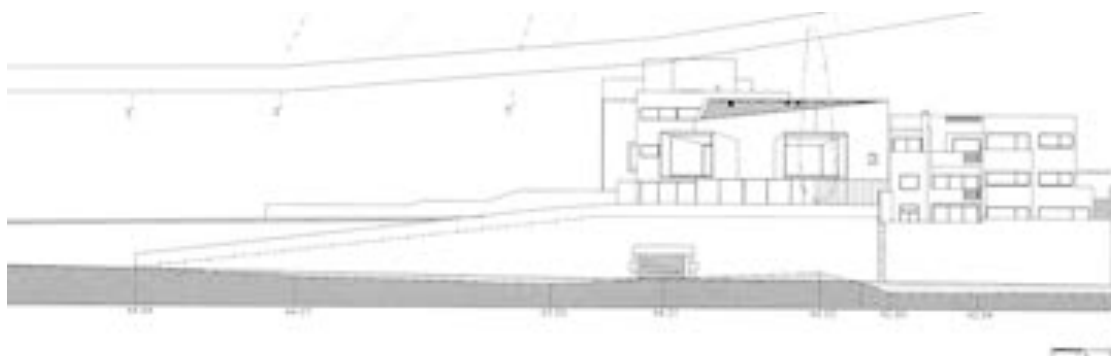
Alçado longitudinal da vista Norte (Souto Moura, Caleidoscópio, 2004)
